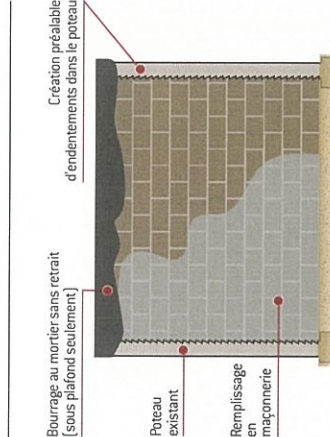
Création d'un mur en maçonnerie entre 2 poteaux existants (élévation)
